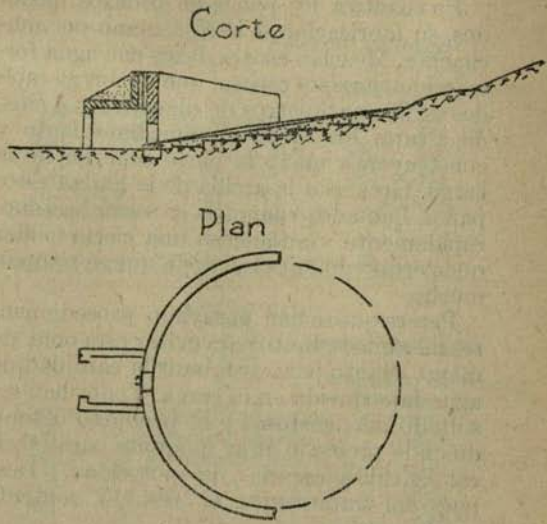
Calcarone no enterrado. Plan y Corte.
